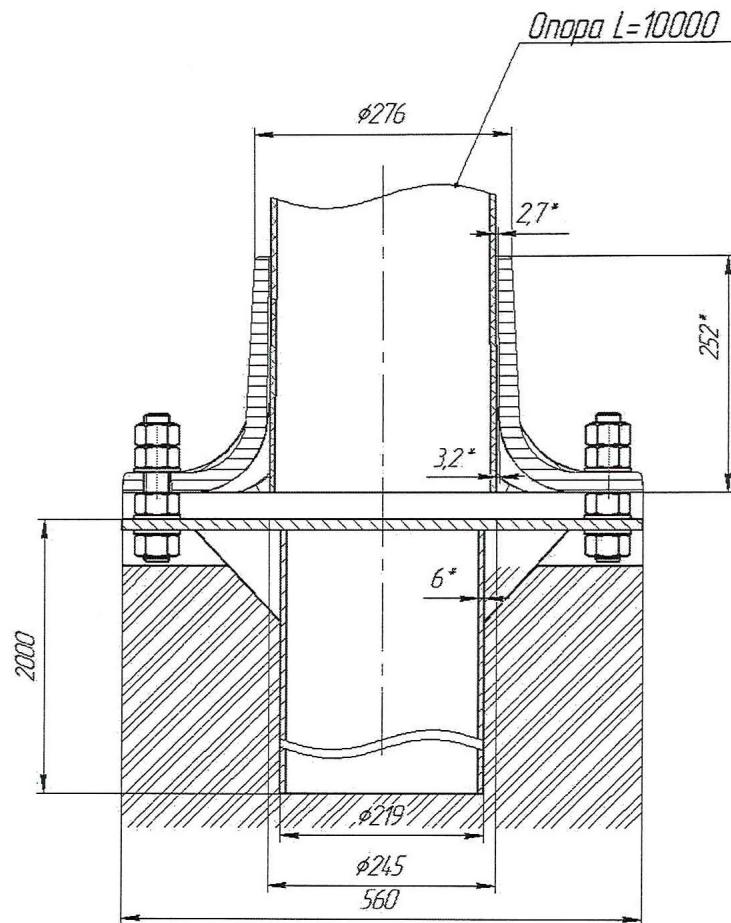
Способ установки опоры с композитным фланцем
